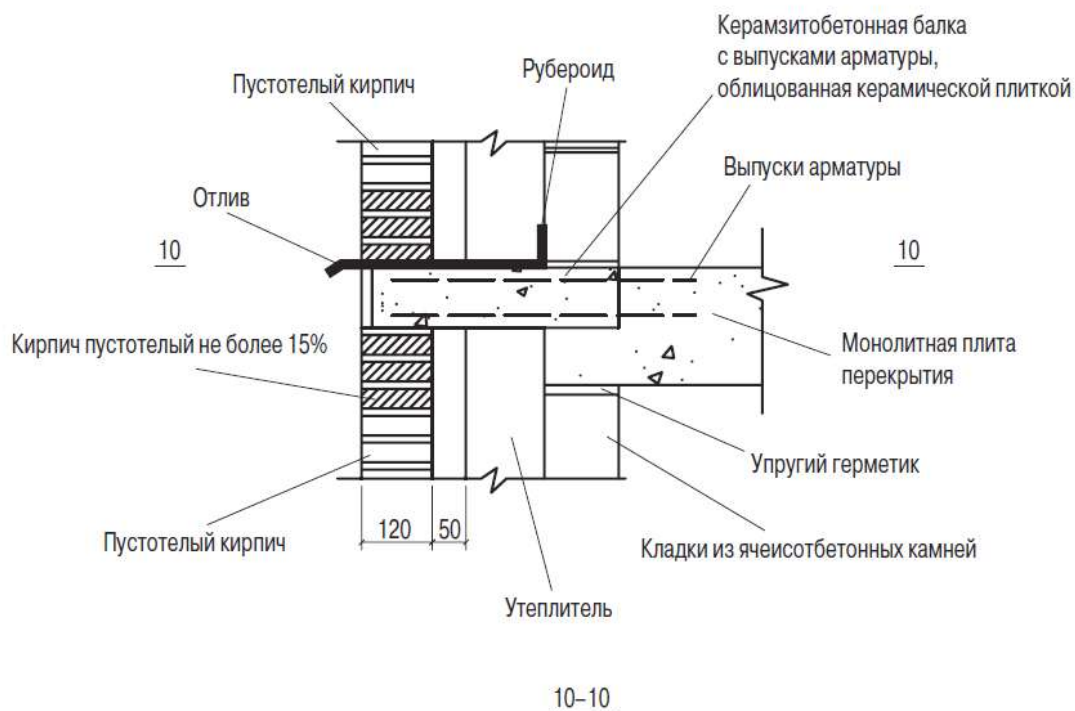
Схема устройства отлива в уровне перекрытия при опирании наружного слоя на керамзитобетонную балку. Разрез10-10.
